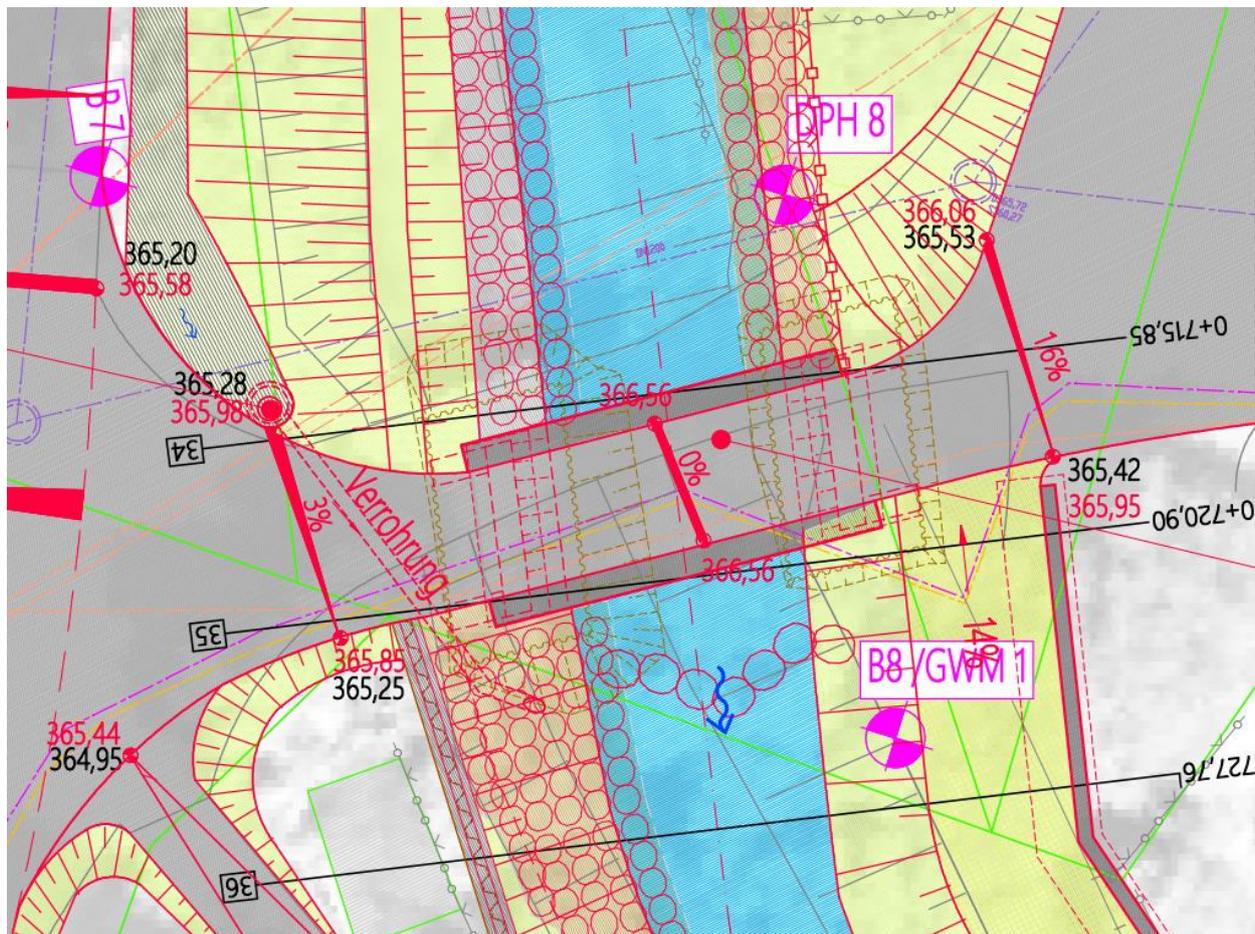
Ausschnitt Lageplan Brücke Karl-Moll-Straße
